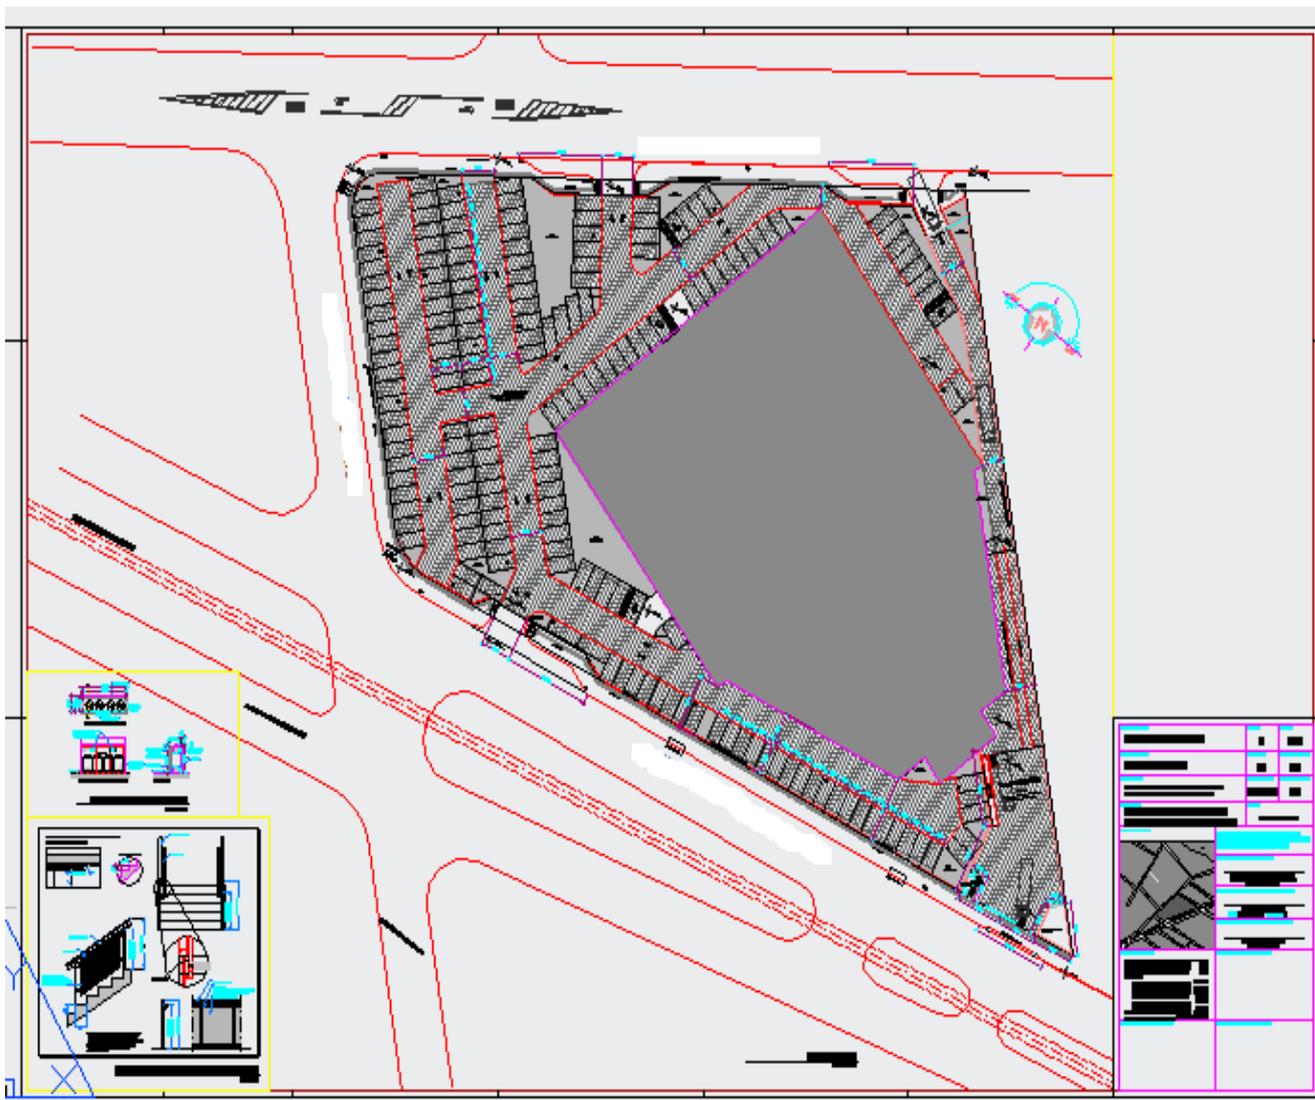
Recorte da planta de implantação e cobertura do terreno.
